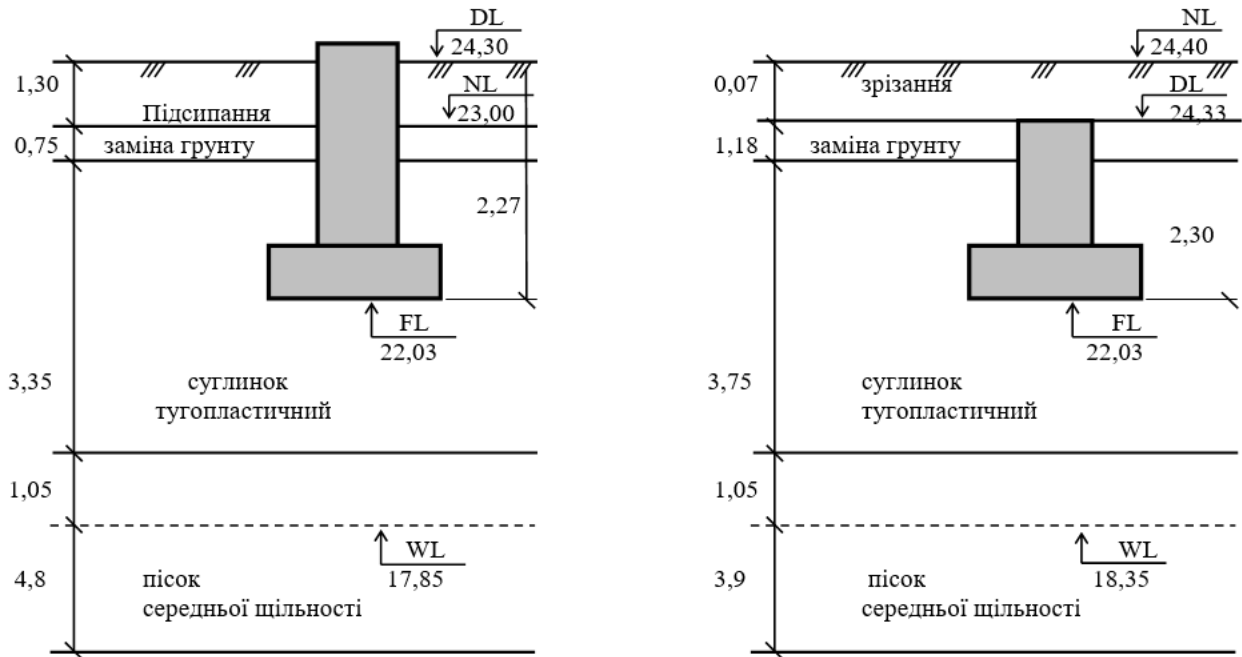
Планування підсипкою та зрізанням ґрунтів:
